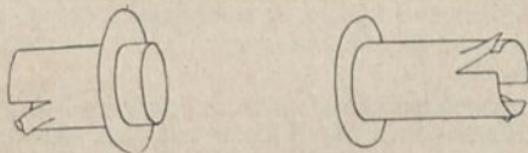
Zinkhülsen für Rohrdurchführungen durch Wände und Decken.
